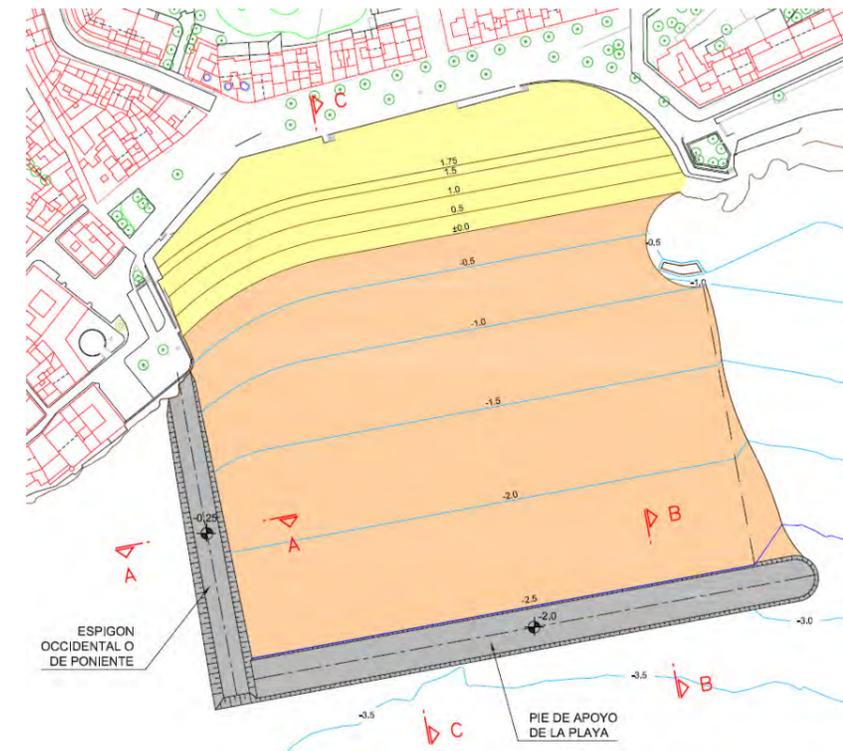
Planta de la Alternativa 3. (Fuente: Elaboración propia)
